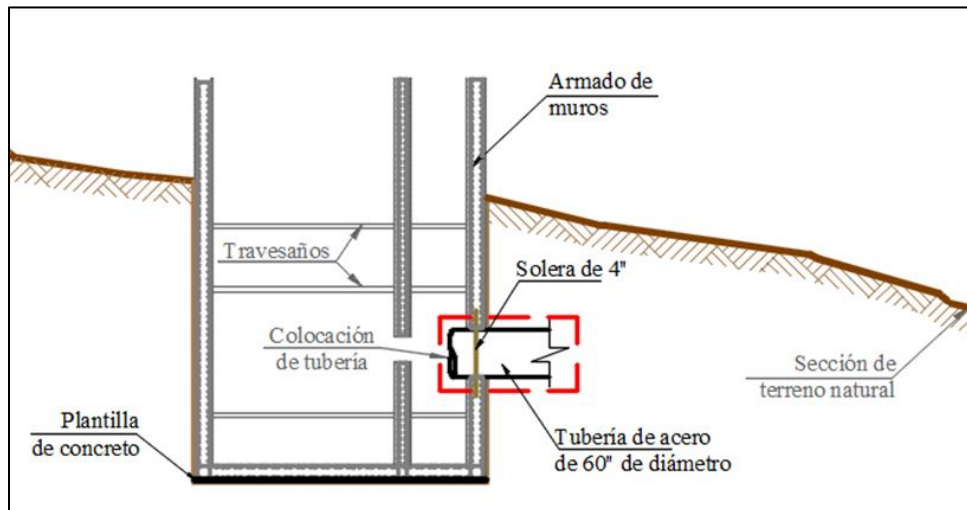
Colocación de plantilla de concreto y tramo de tubería de captación.
